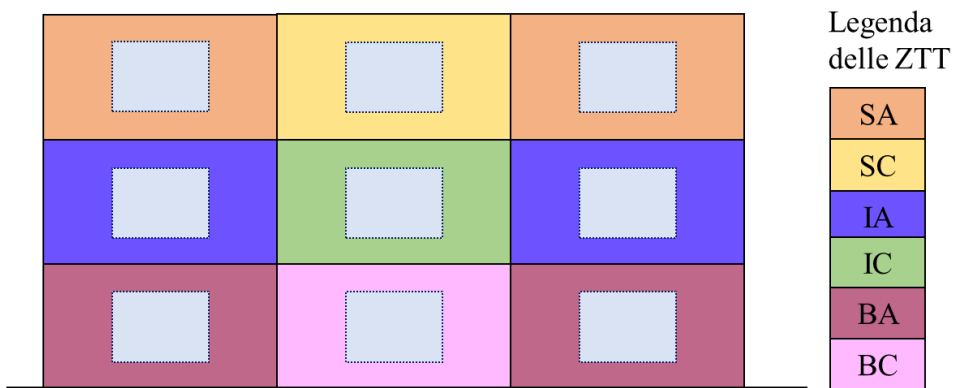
Schema di facciata del Building Energy Concept e delle Zone Termiche Tipo.
